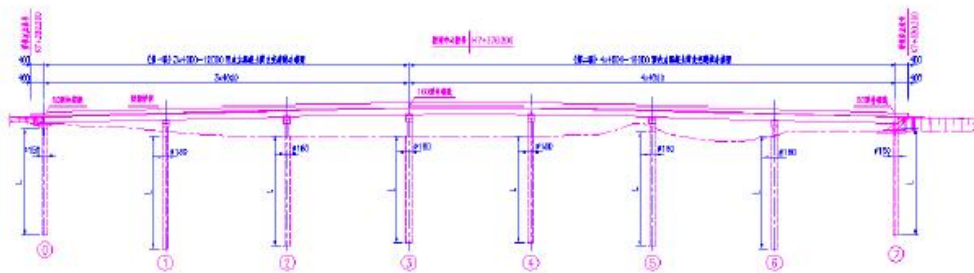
(3x40+4x40) m 预应力混凝土小箱梁立面图
